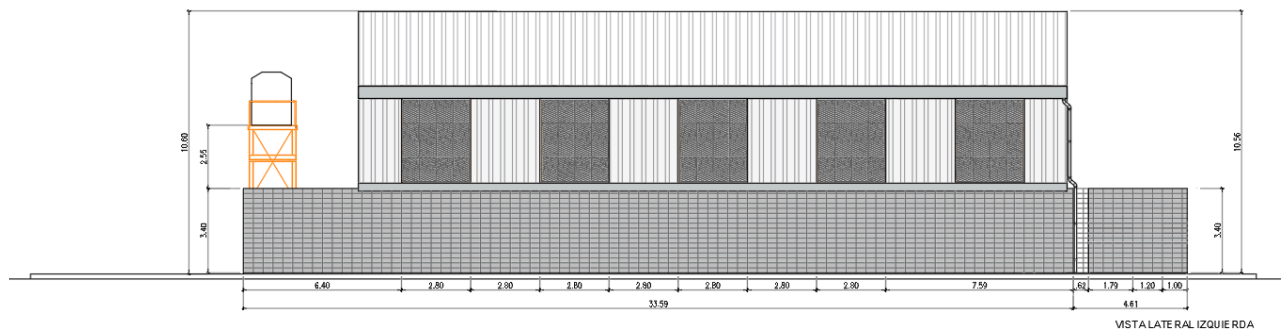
PLANTA DE CLASIFICACIÓN | VISTA LATERAL
